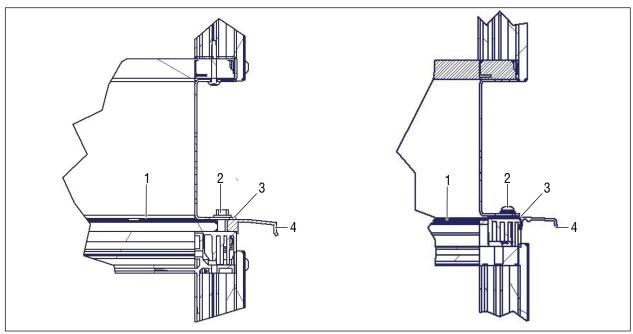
Disposition des appareils groupe de toit avec profil de cadre d'appareil (à gauche) et sans profil de cadre d'appareil (à droite)
